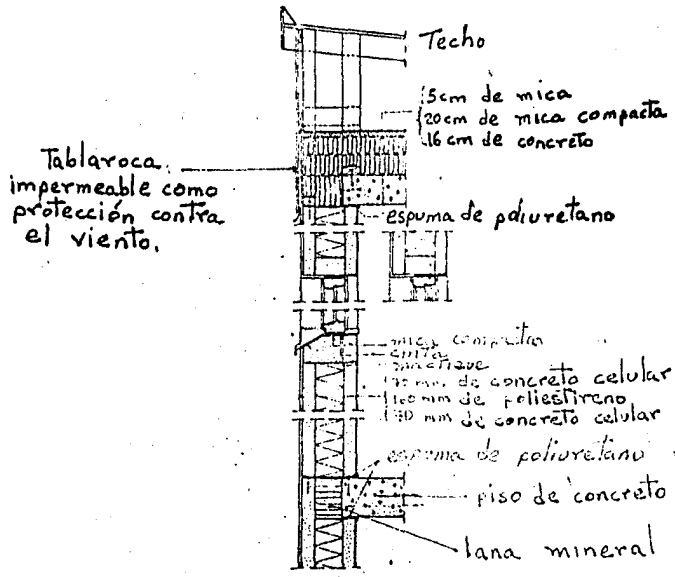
Técnicas constructivas para el aislamiento de muros, losas, techos, etc.
